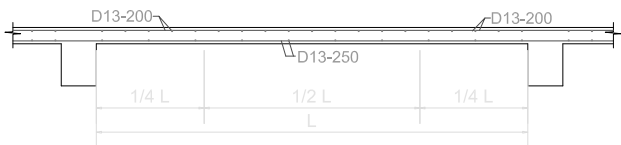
DETAIL DENAH PENULANGAN PELAT S1 (t=120 mm)
